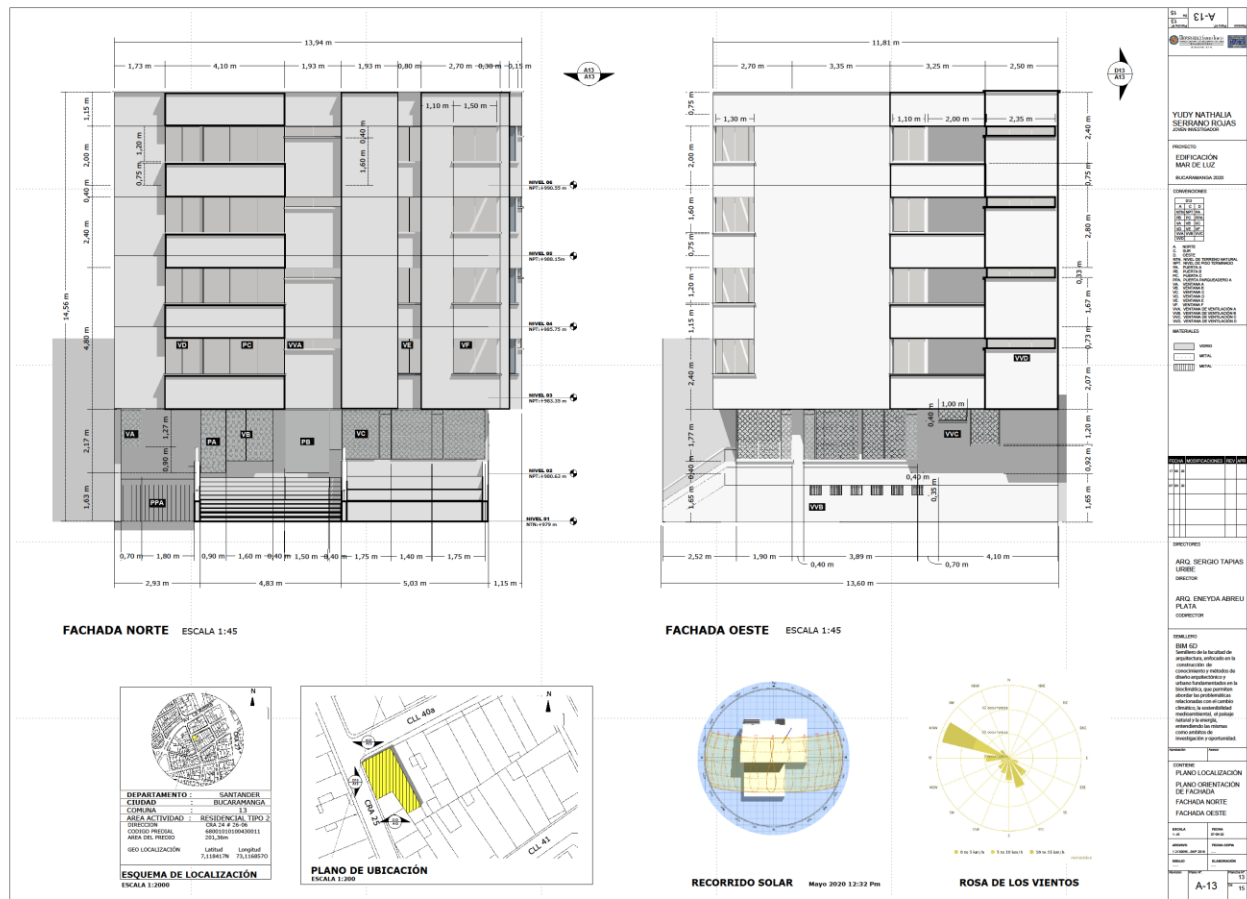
Levantamiento arquitectónico, plancha 13 (Localización, componente ambiental, fachada norte y fachada oeste) edificación “Mar de Luz”, 2000.
